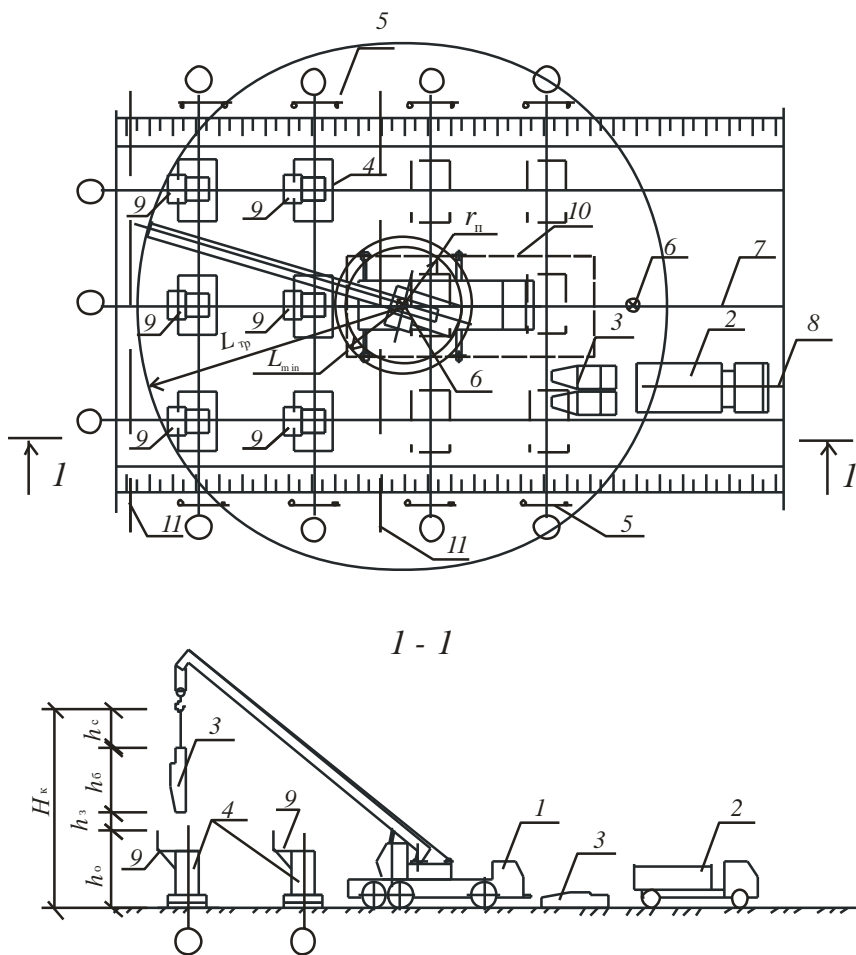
Схема бетонирования фундаментов со дна котлована:
